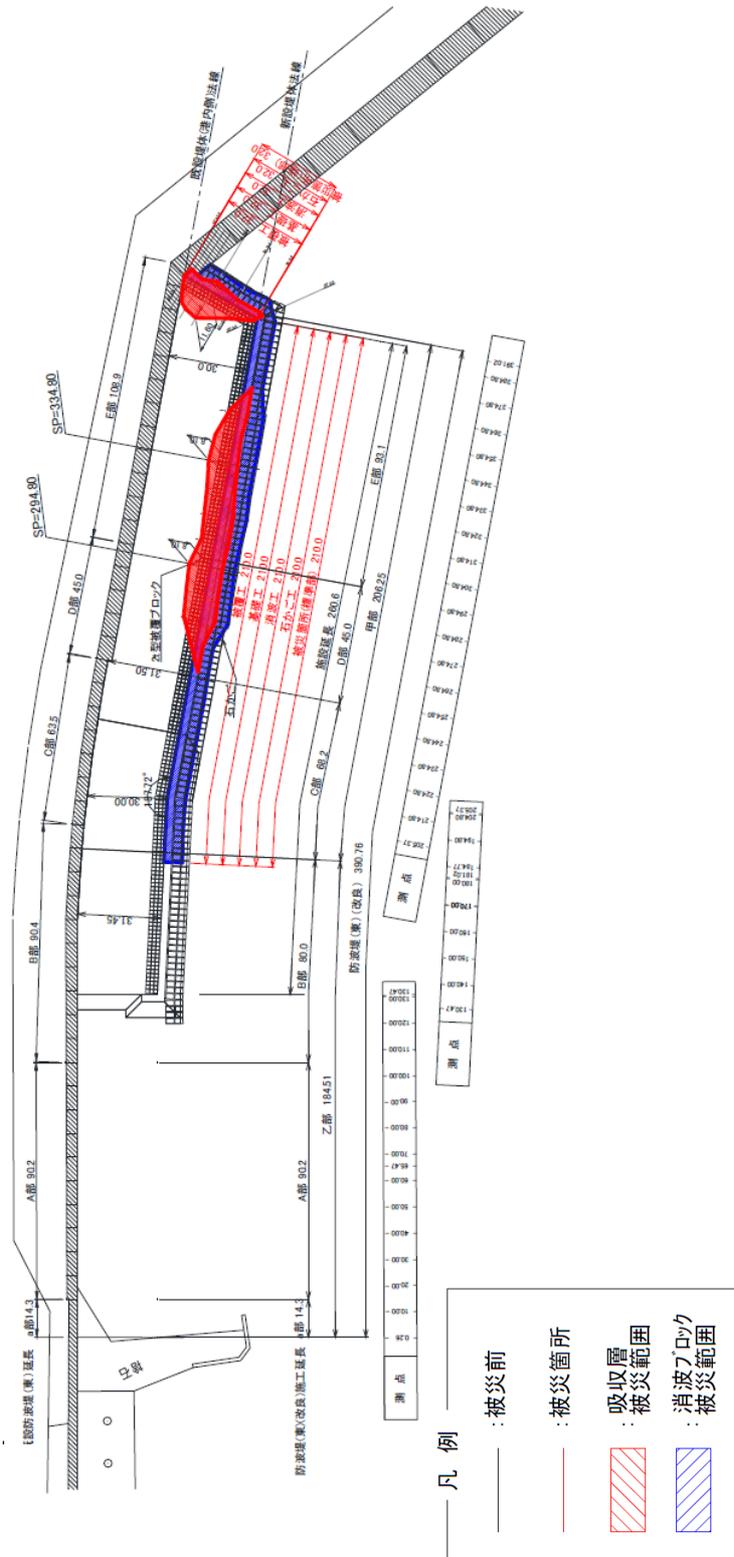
No.1 西港外港地区_東防波堤の平面図 (被災前後)
